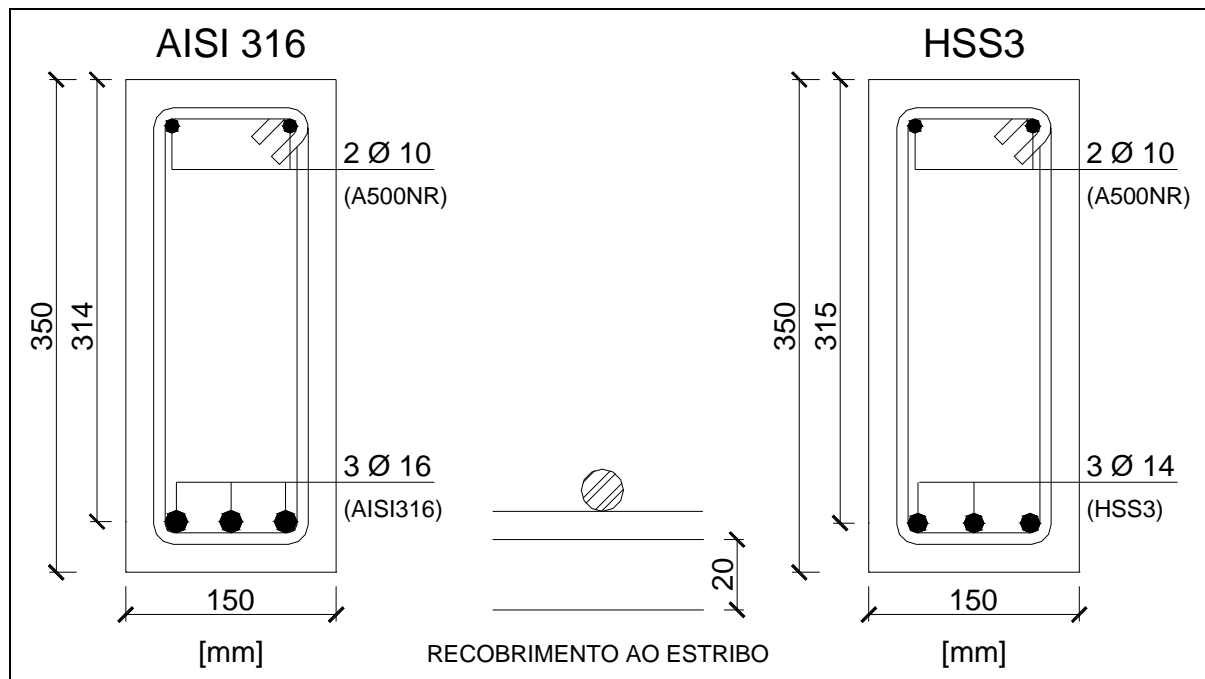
Detalhe da secção transversal das vigas de aço inoxidável da 2.^a série.
